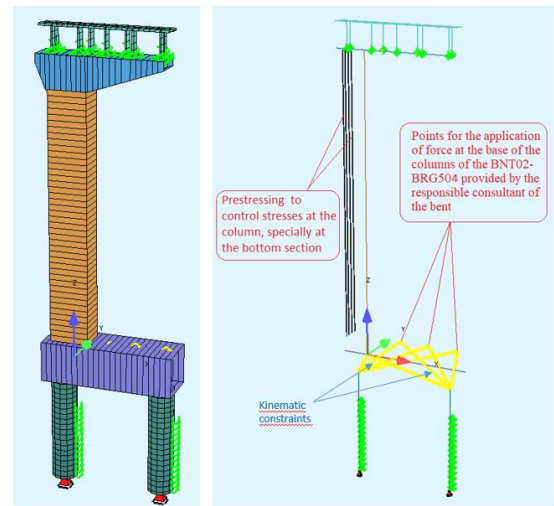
Modelo de cálculo para la pila 18, excéntrica, del puente 113B y su cimentación conjunta con la pila 2 del puente 504.
